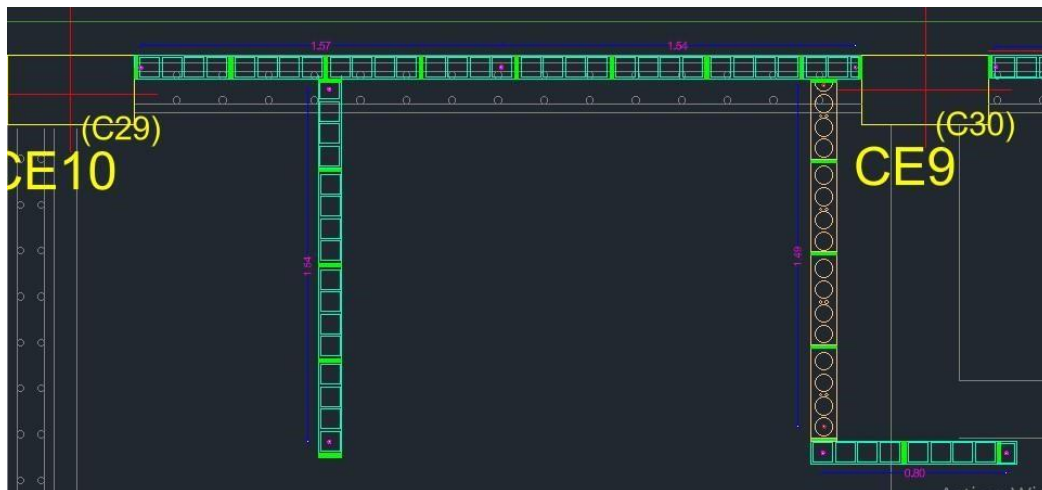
Detalles muros no estructurales piso 5 a 8
